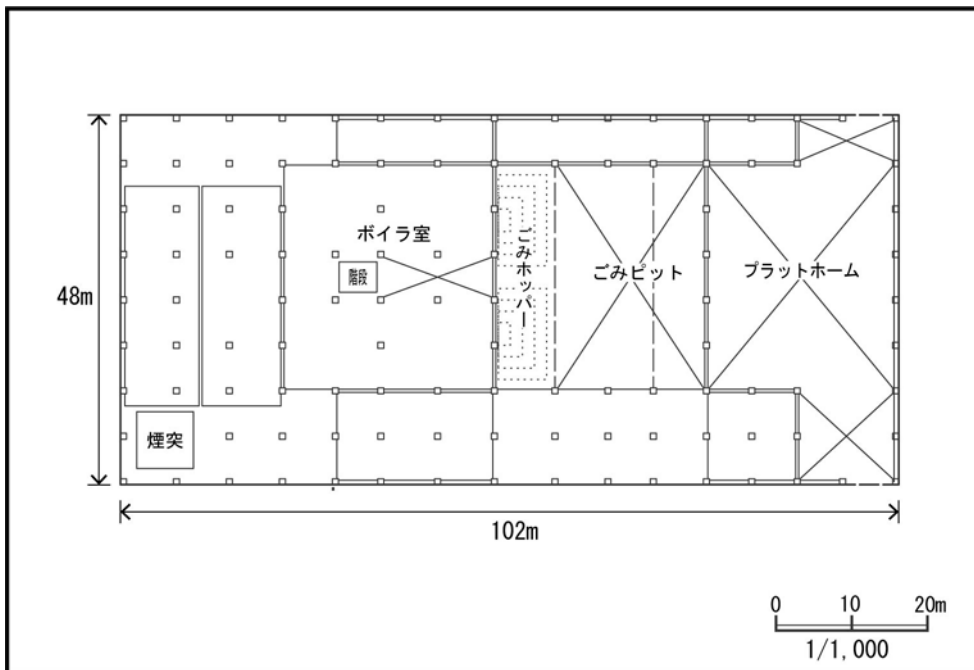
(4) 新施設の平面図 (新焼却処理施設 3 階)
